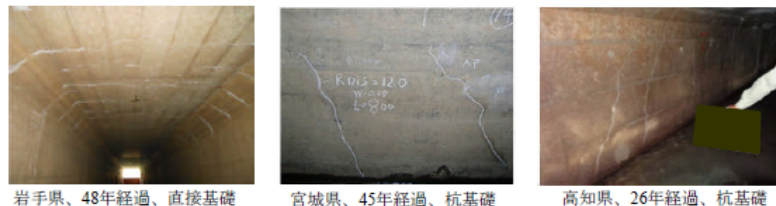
④函軸直角方向・壁面斜め方向のひび割れの例
